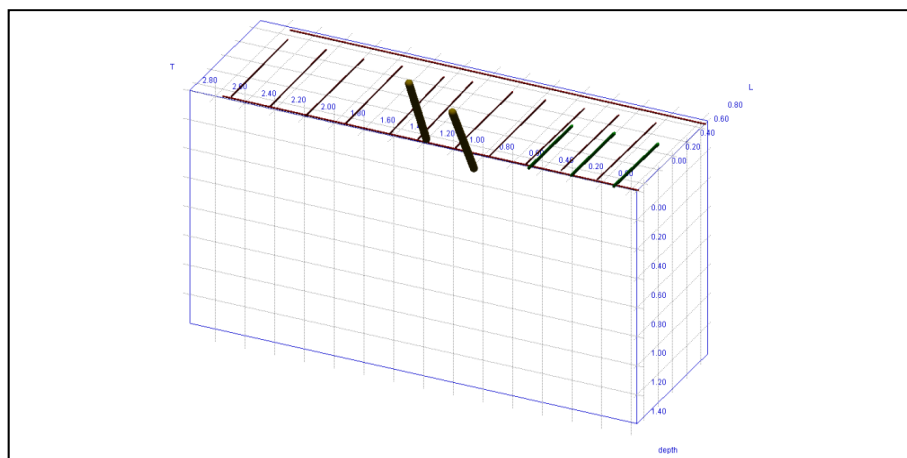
MODELLO 3D, VISTA PROSPETTICA
